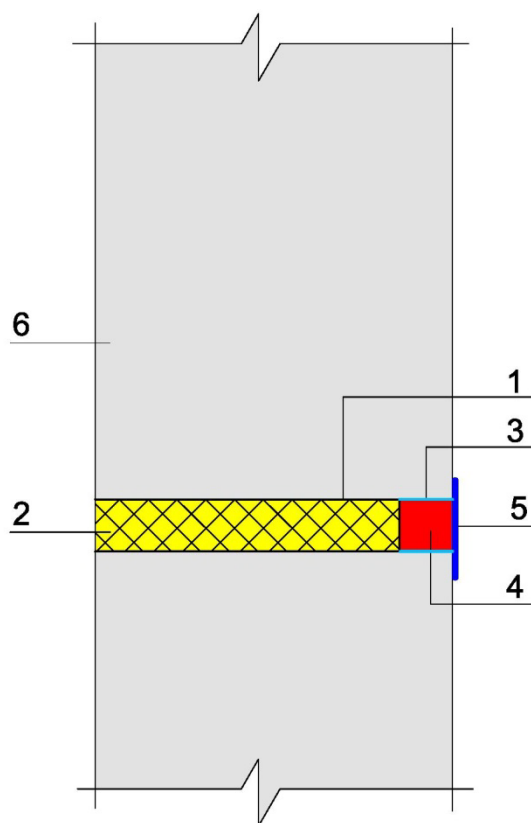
Гидроизоляция технологических отверстий от стяжек опалубки:
